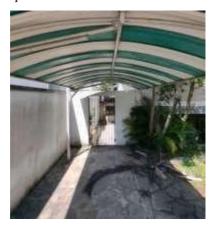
ÁREA EXTERNA – FACHADA PRINCIPAL: Cobertura em toldo com estrutura
